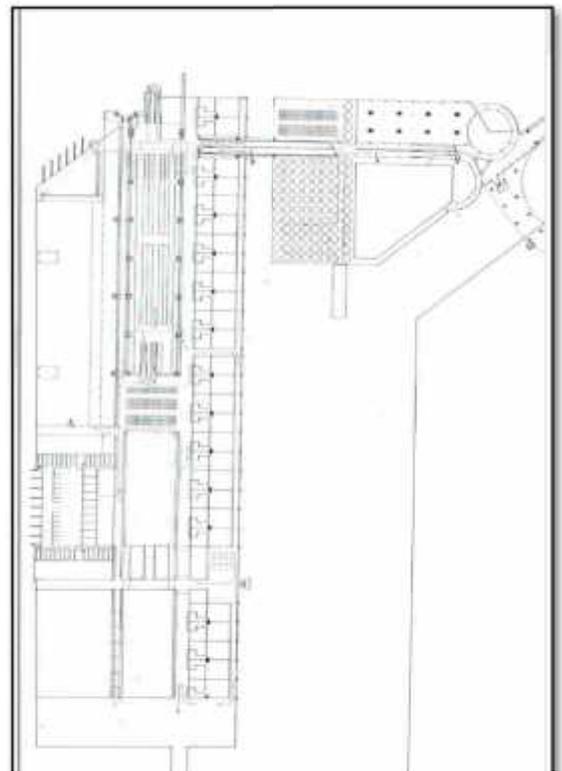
l'Ilot du Tronchetto.plan du rez de chaussée. sr R.Bocchi.
